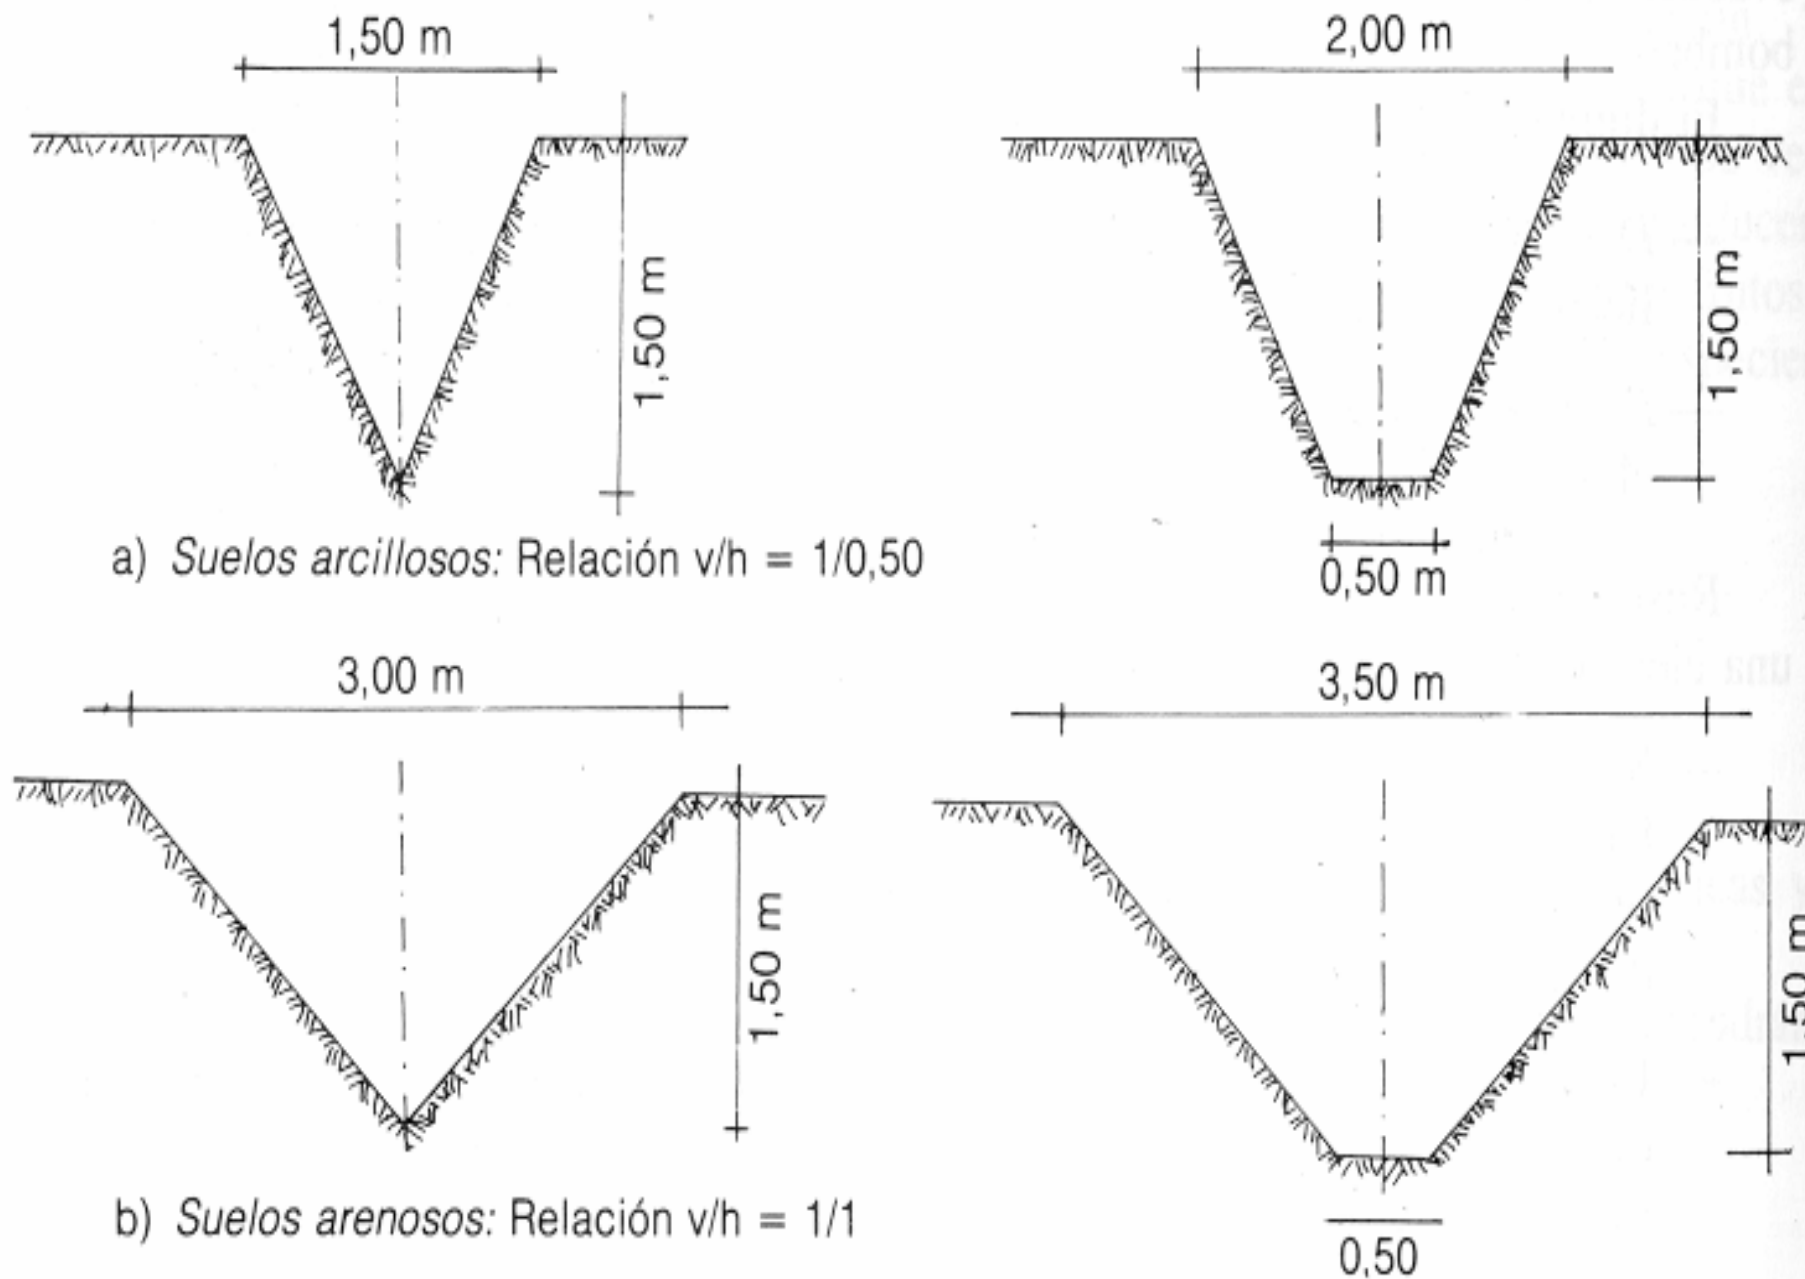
Zanjas de drenaje: secciones trapecial y uve
